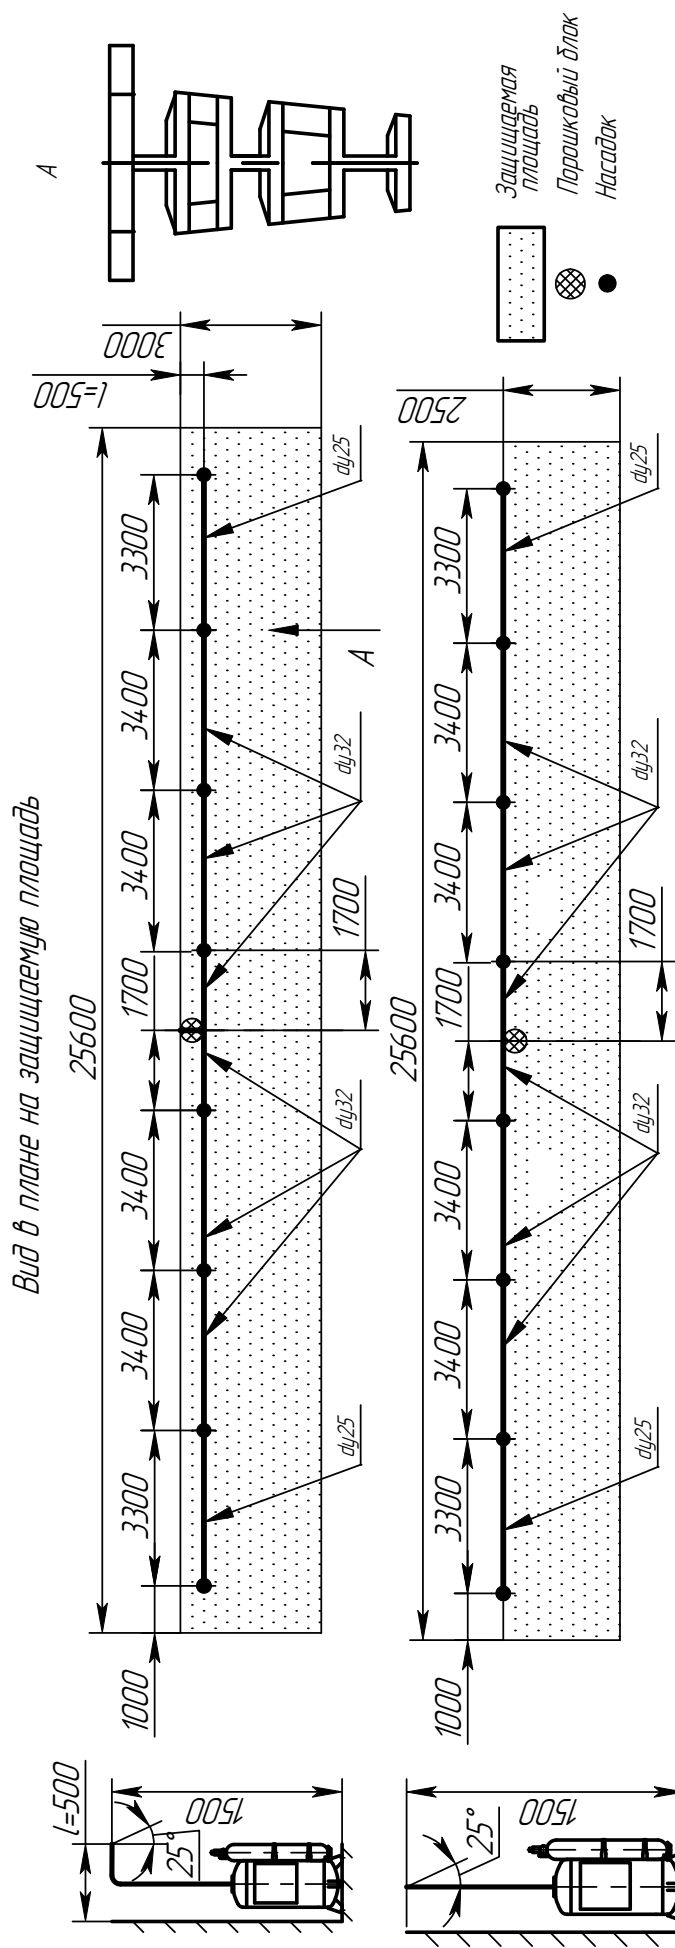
Распределительный трубопровод и расположение насадок для варианта размещения 2
